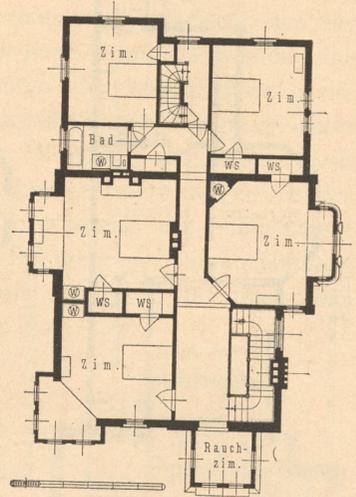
u. 254<sup>236</sup>) zeigen den Grundriss vom Erdgeschoss und Obergeschoss eines Wohnhauses zu New-Haven (Arch.:
